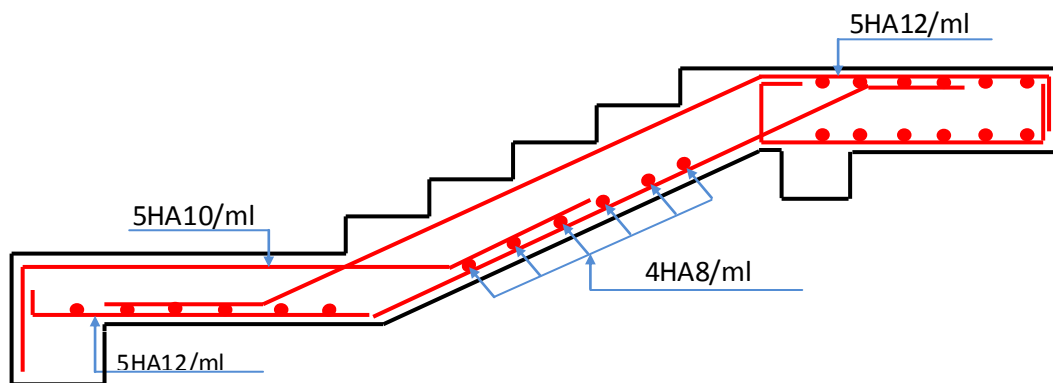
schéma de ferrailage du 1^{er} type d'escalier (SS1)
